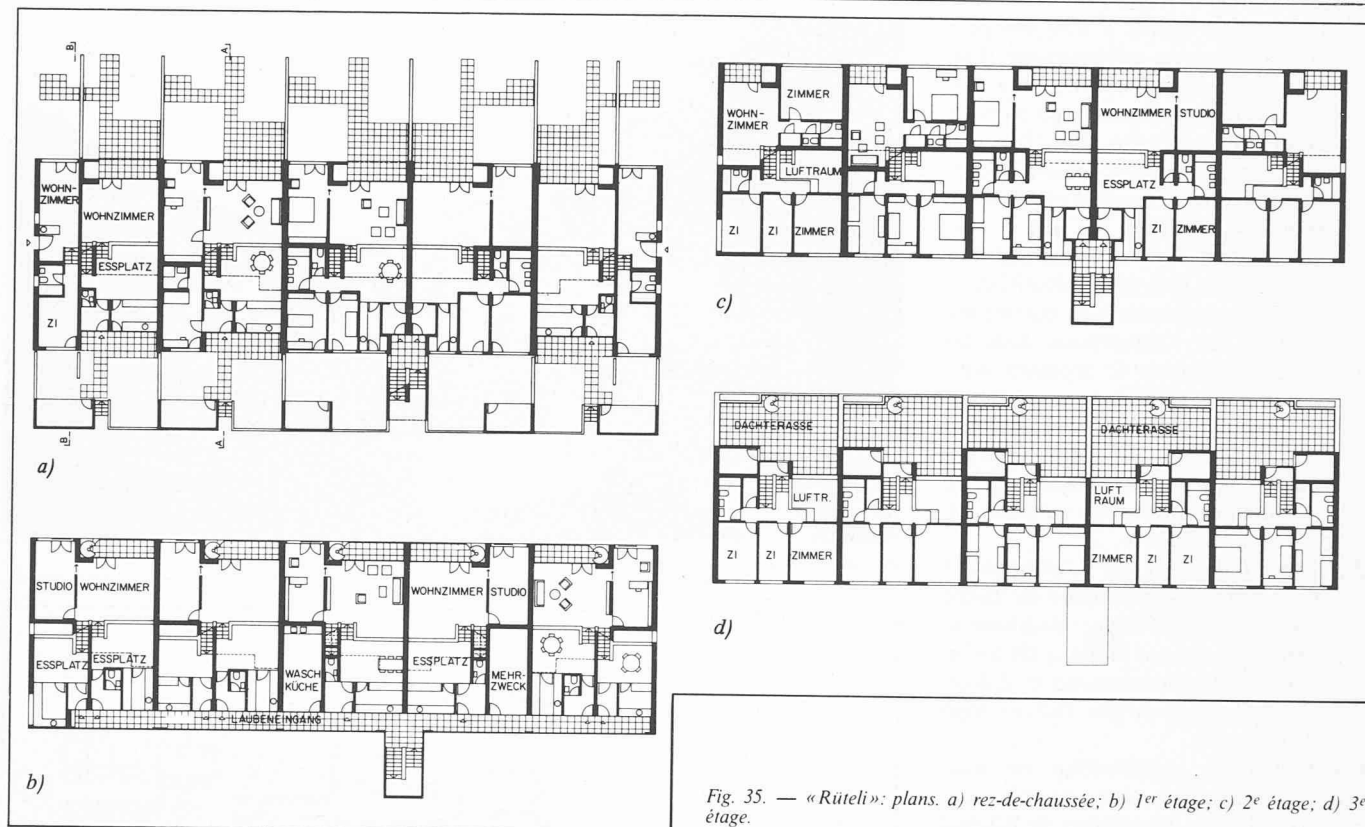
«Rüteli»: plans. a) rez-de-chaussée; b) 1^{er} étage; c) 2^e étage; d) 3^e étage.
